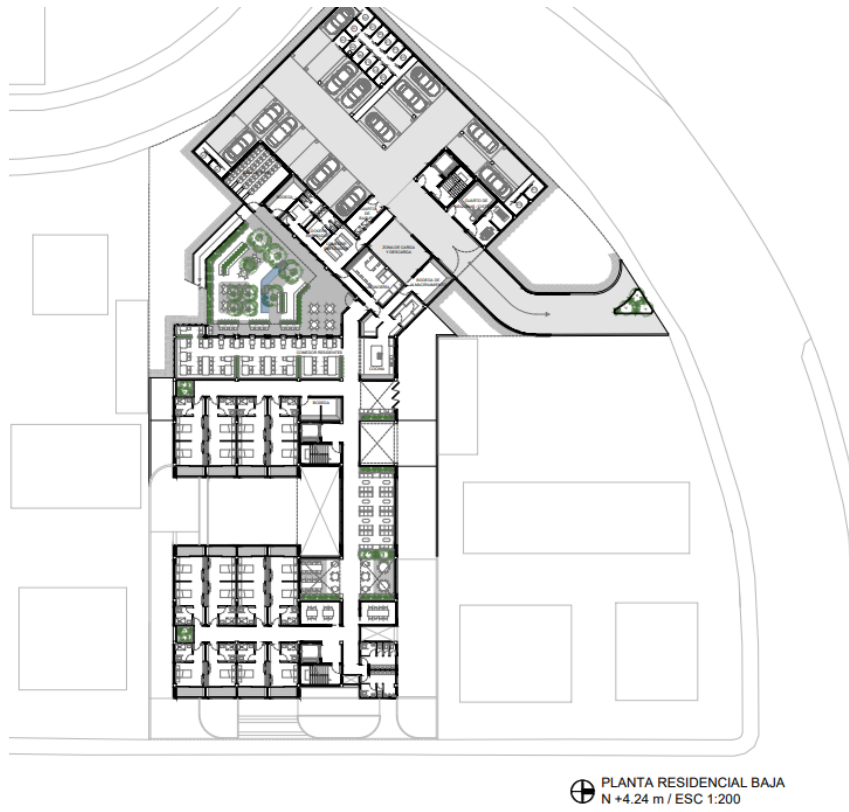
Planimetría: Planta Residencial Baja (N +4.24 m)
